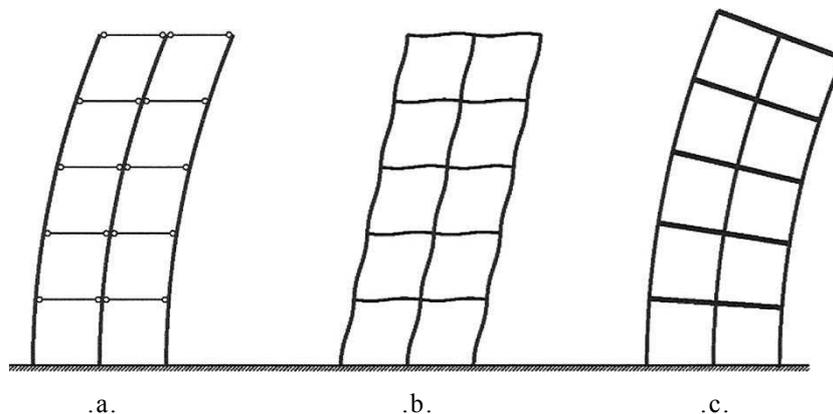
Deformaciones de pórticos frente a acciones laterales: a) Vigas de rigidez despreciable, b) Vigas de rigidez similar a la de los pilares y c) Vigas de gran rigidez. (Imagen tomada de [Gómez Hermoso et al. 2013, 260]).
